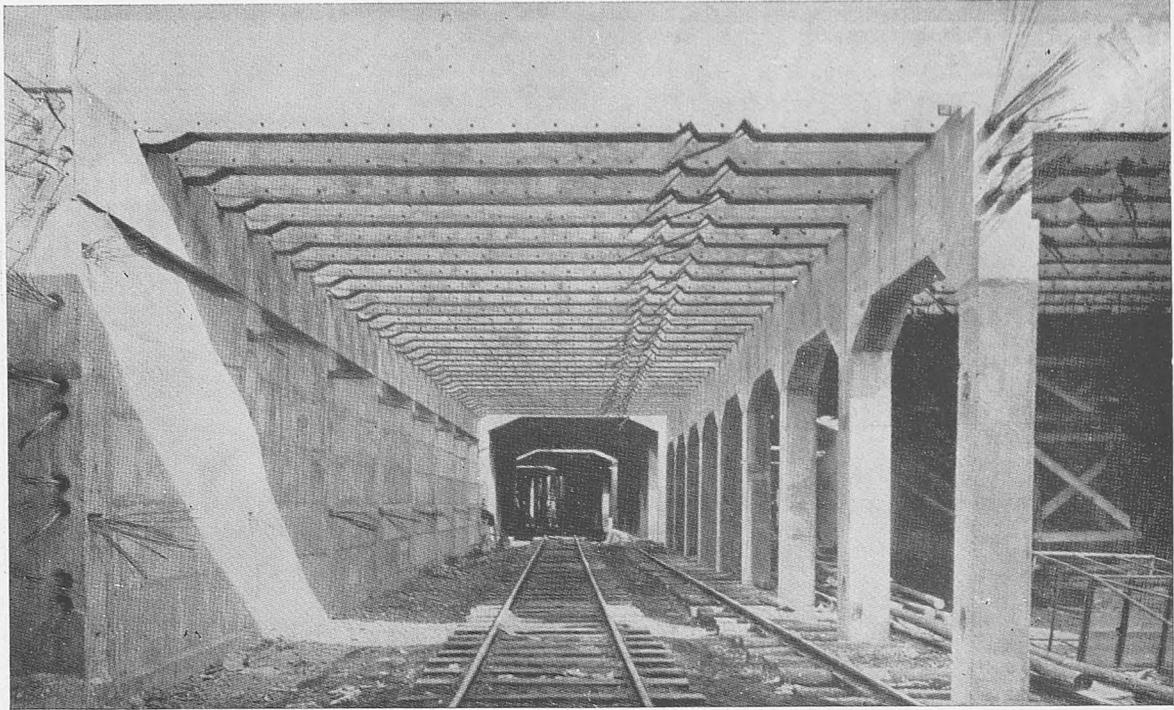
Enlace de piezas prefabricadas en una estructura de Rouen.
